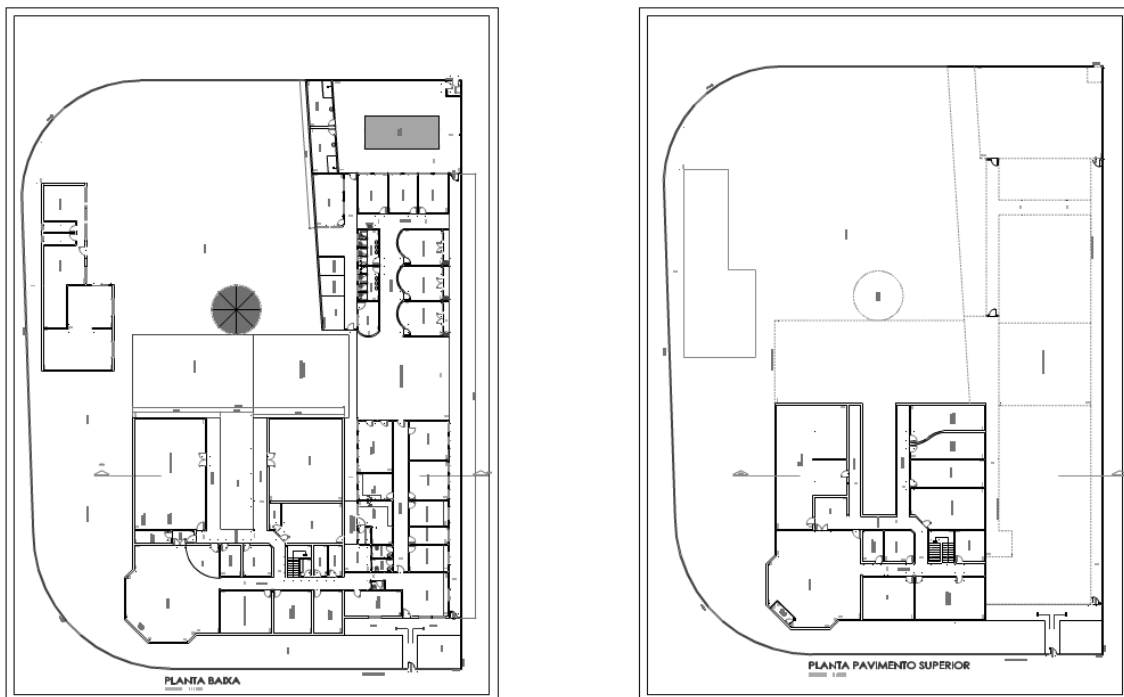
Planta baixa da sede da Fundação Síndrome de Down
